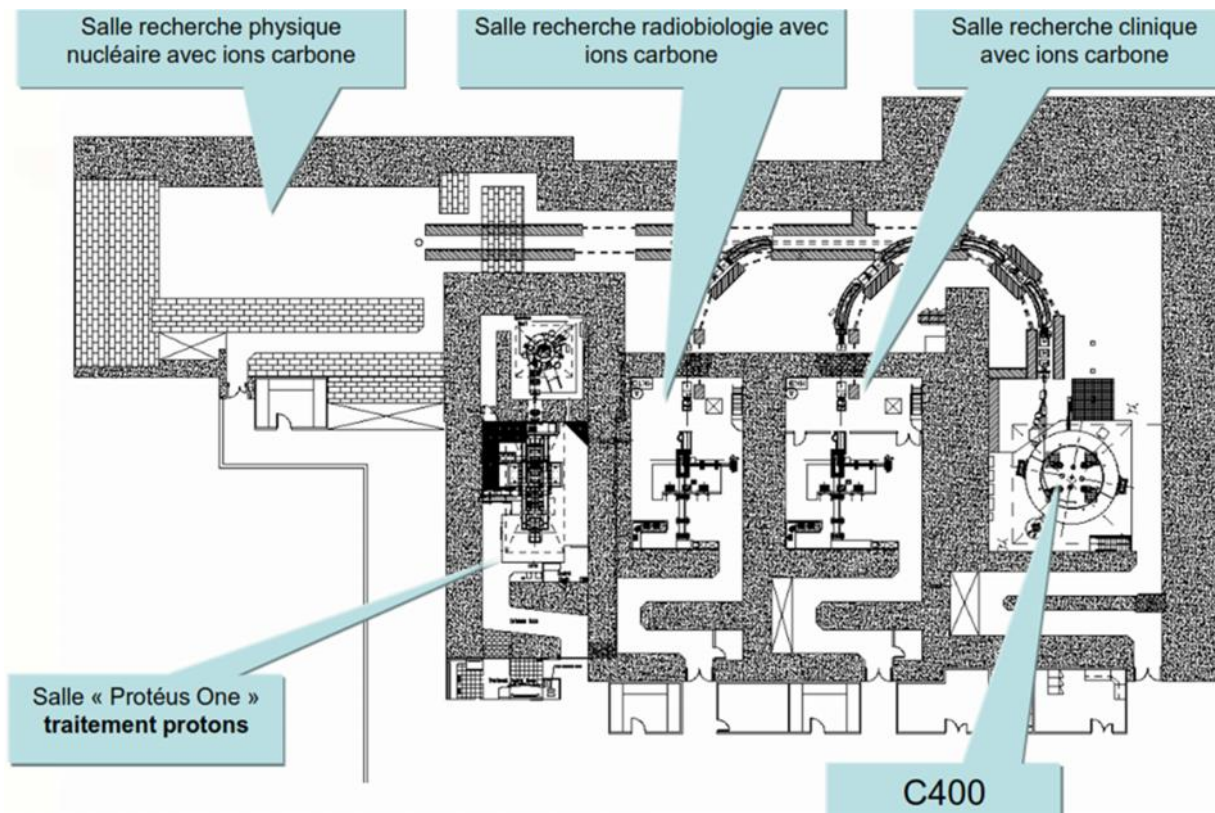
Plan des salles d'irradiation dans le bâtiment ARCHADE.
